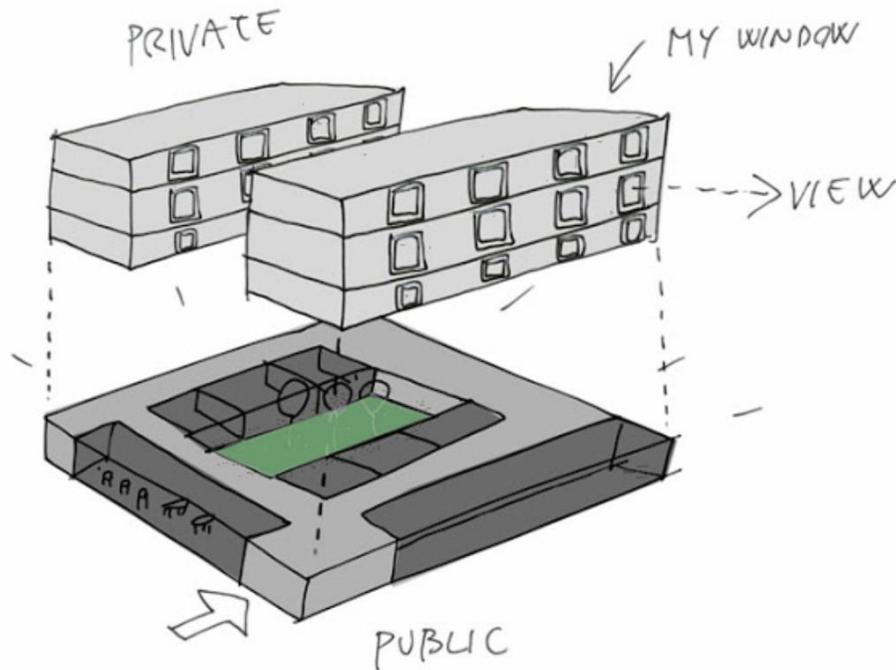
Residência Estudantil de Poljane, croqui, planta pavimento tipo.
